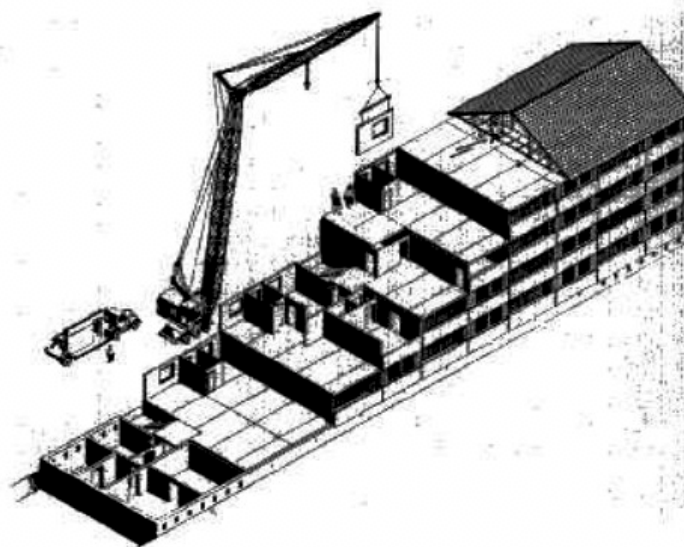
Modelo de montagem de uma construção modular (Nissen, 1976)
